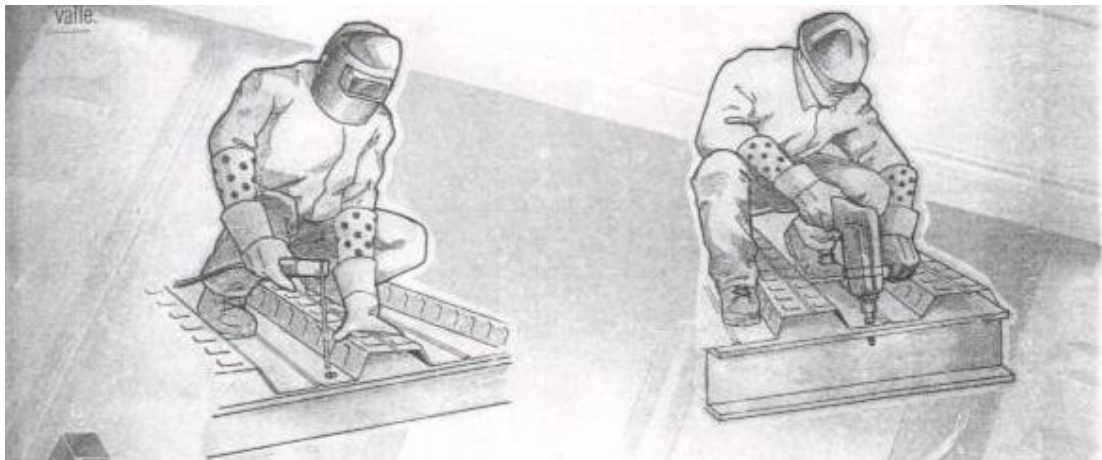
Fijación de la losacero a la estructura de apoyo.
